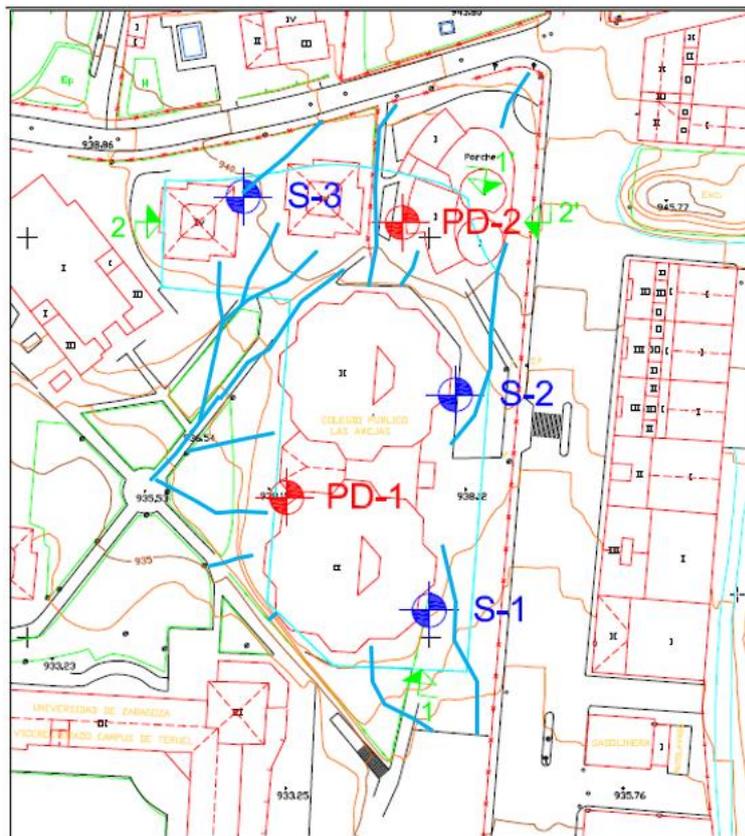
Red de drenaje actual de la parcela basada en el levantamiento topográfico realizado por Geodeser y facilitado por el cliente. En azul la red de drenaje del emplazamiento.
